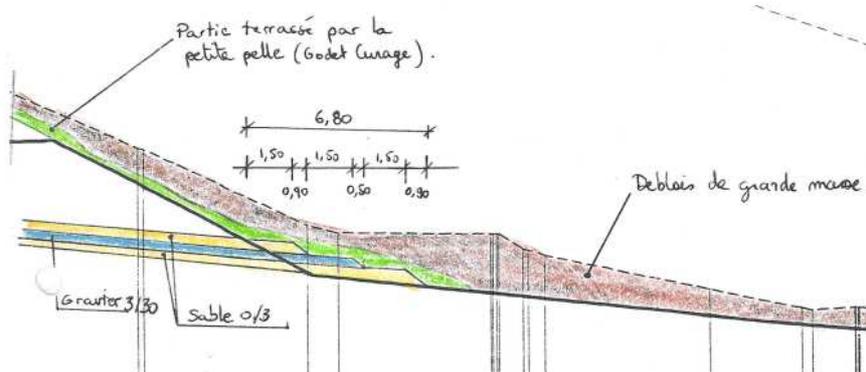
Travaux préparatoires pour le raccordement du tapis drainant existant : en fond de vallée
